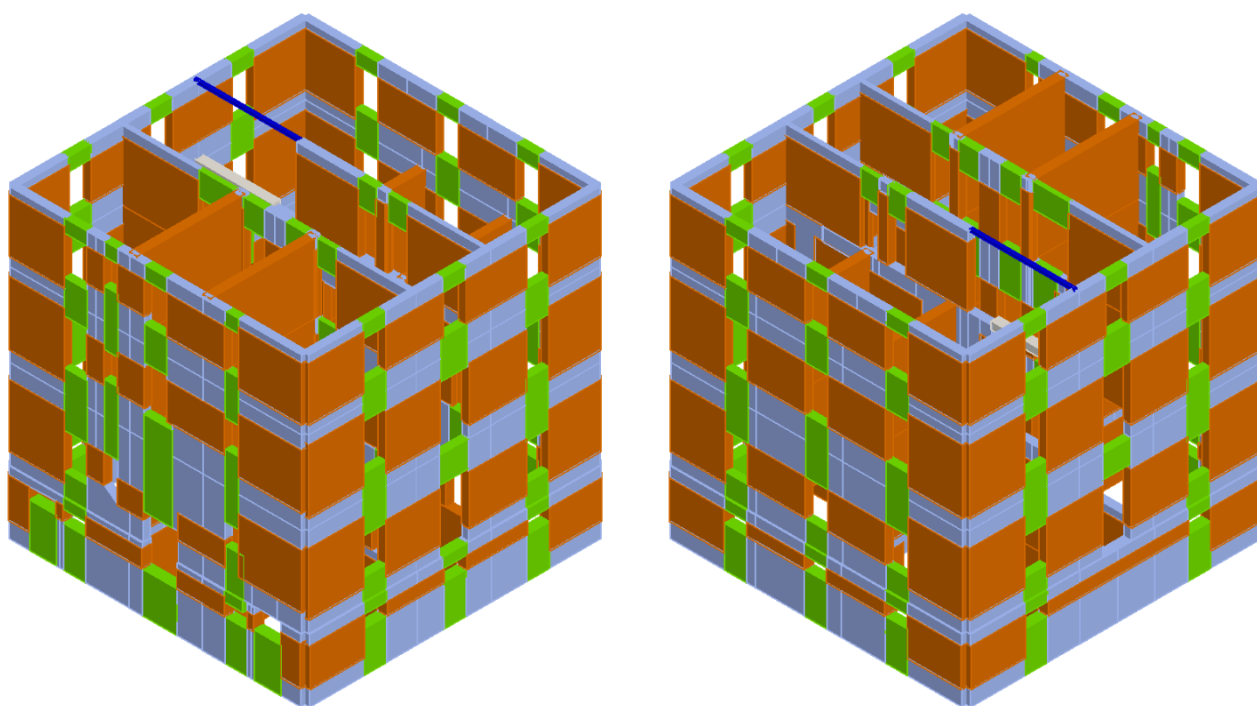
Idealizzazione della parete muraria in telaio equivalente nel caso di disposizione delle aperture regolare (3.16a) e irregolare (3.16b) [17]
